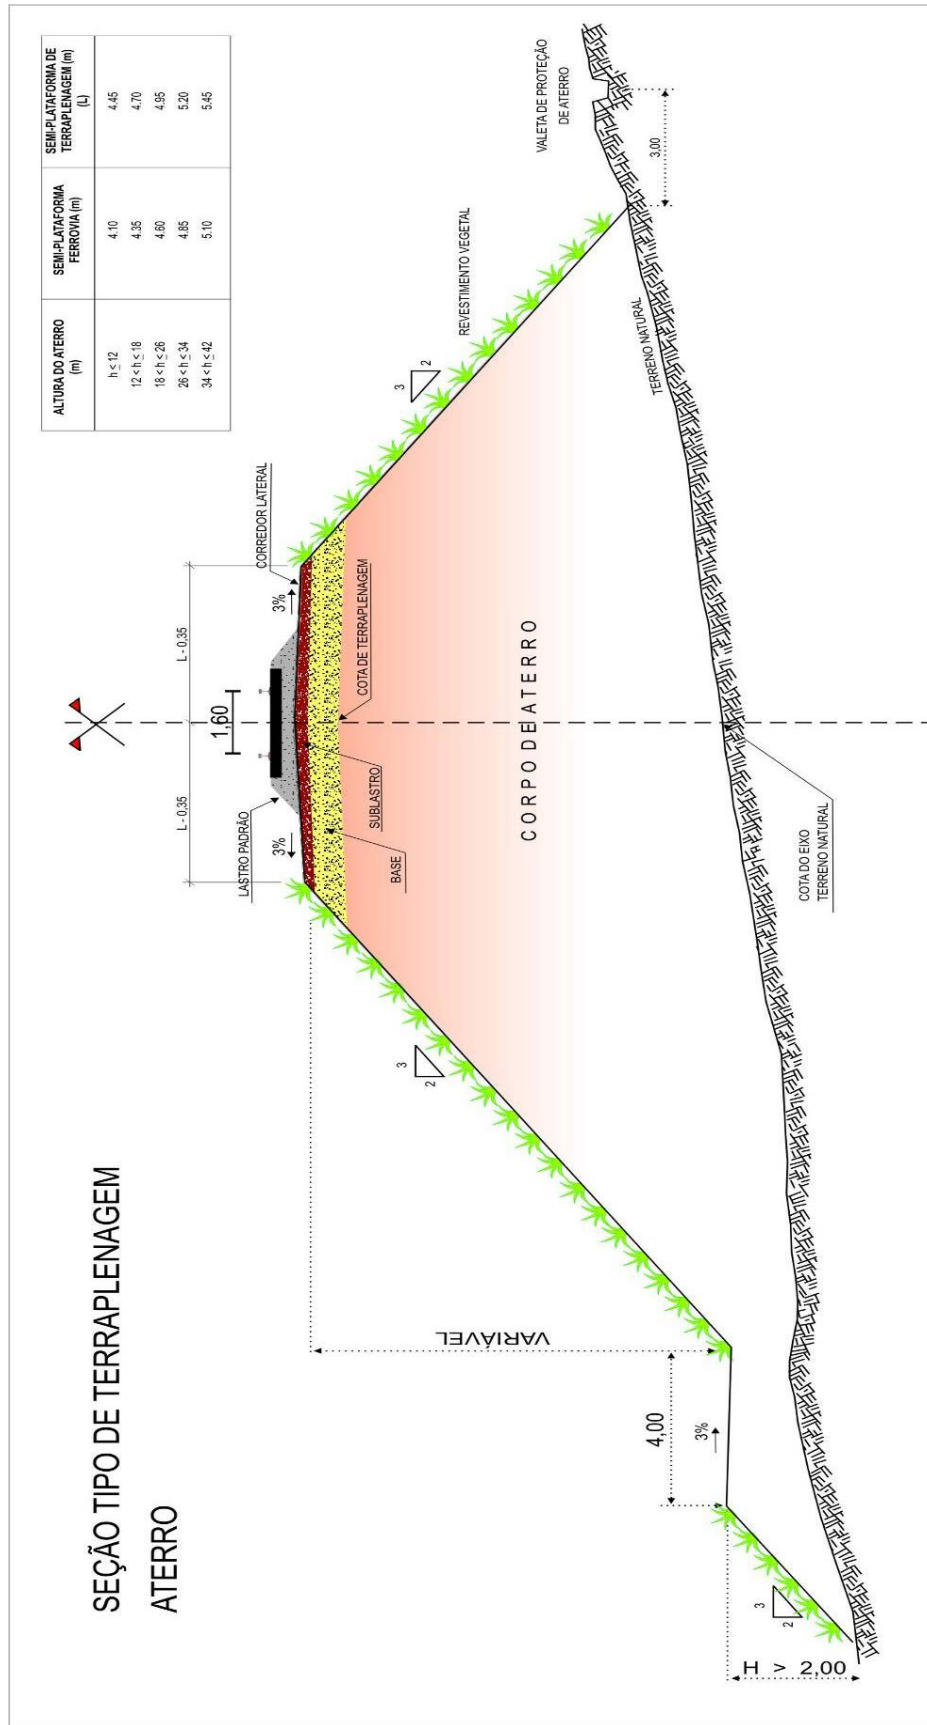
Seção Transversal Tipo de Terraplenagem para Aterro
